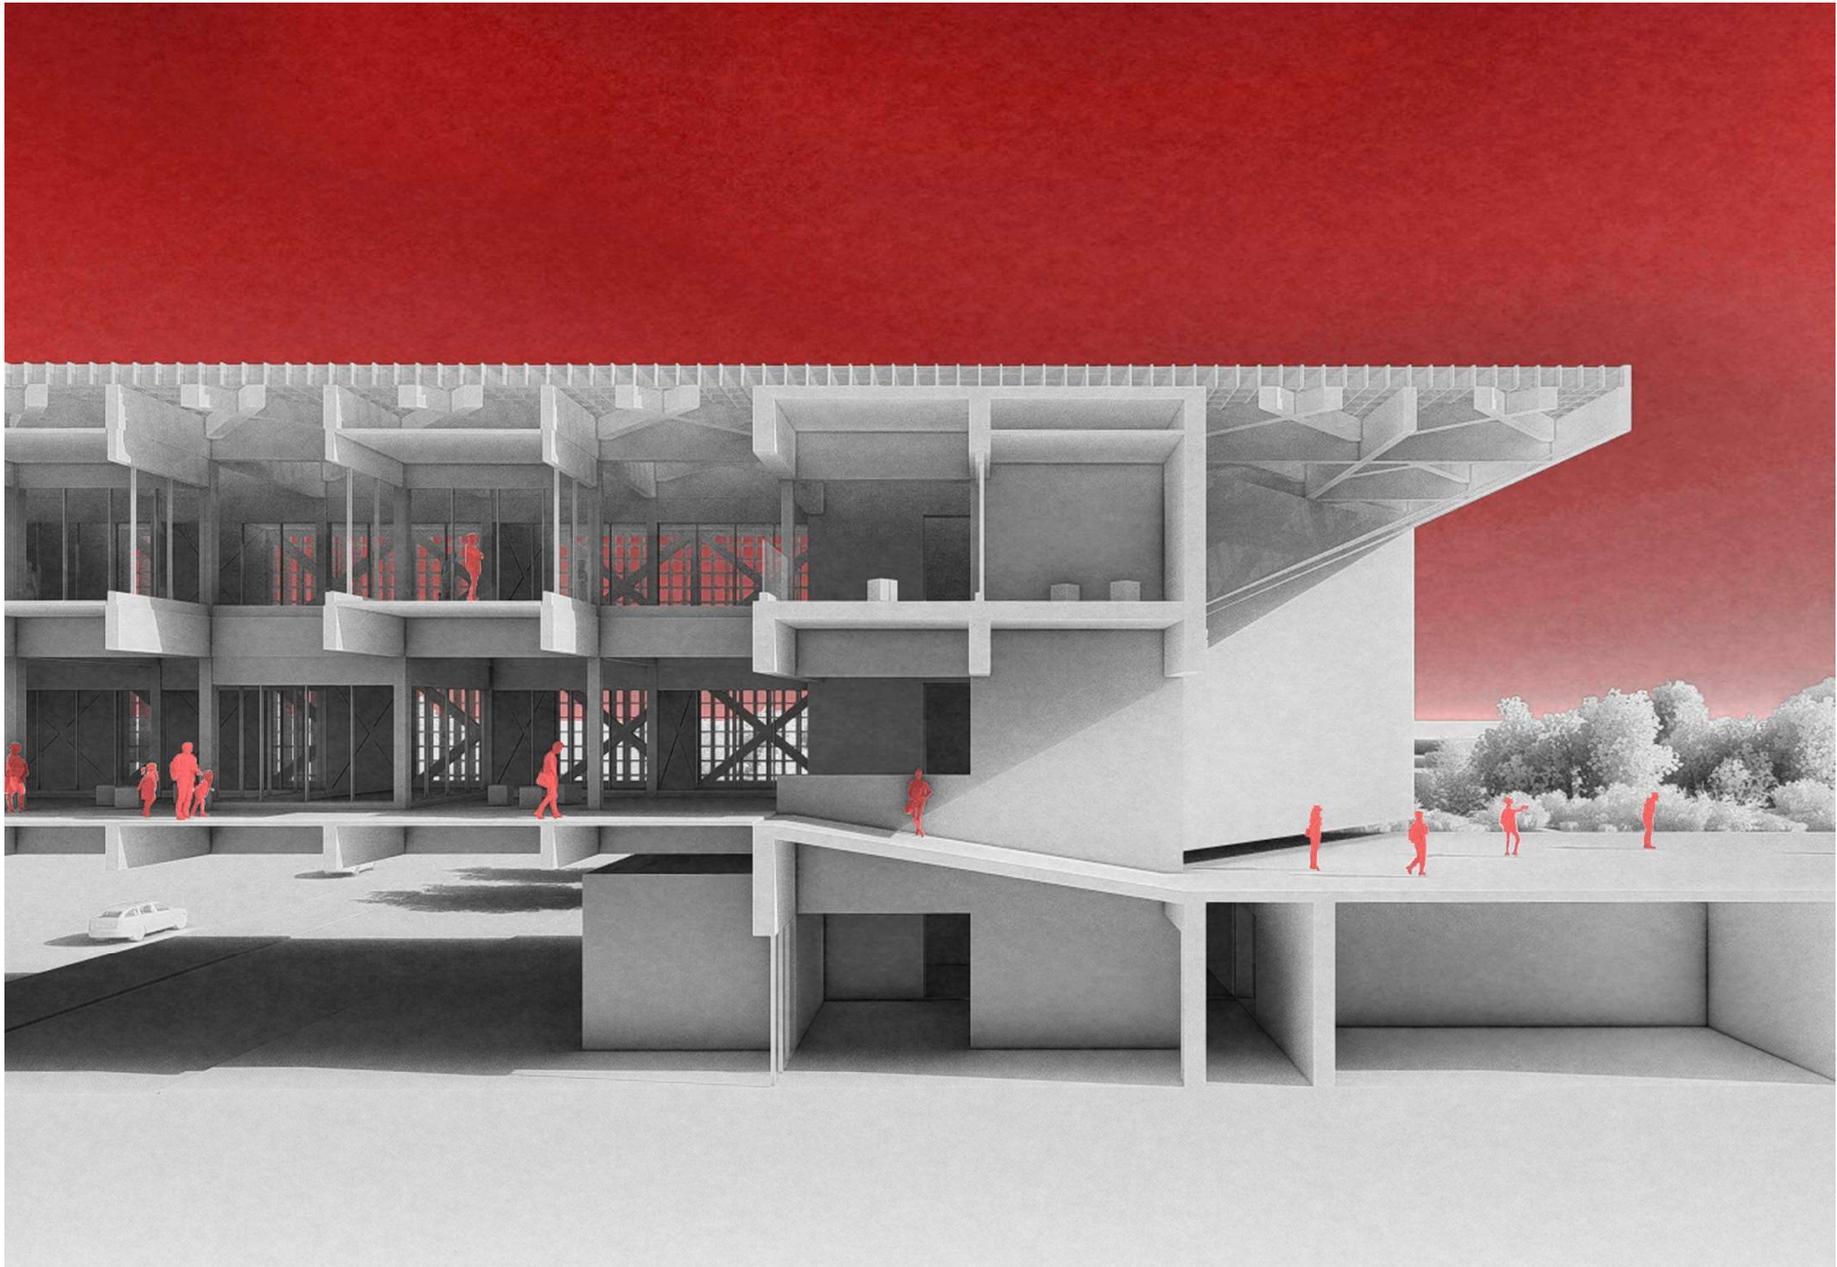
Imágenes conceptuales. Detalle en corte del acceso al dispositivo. Elaboración propia.
